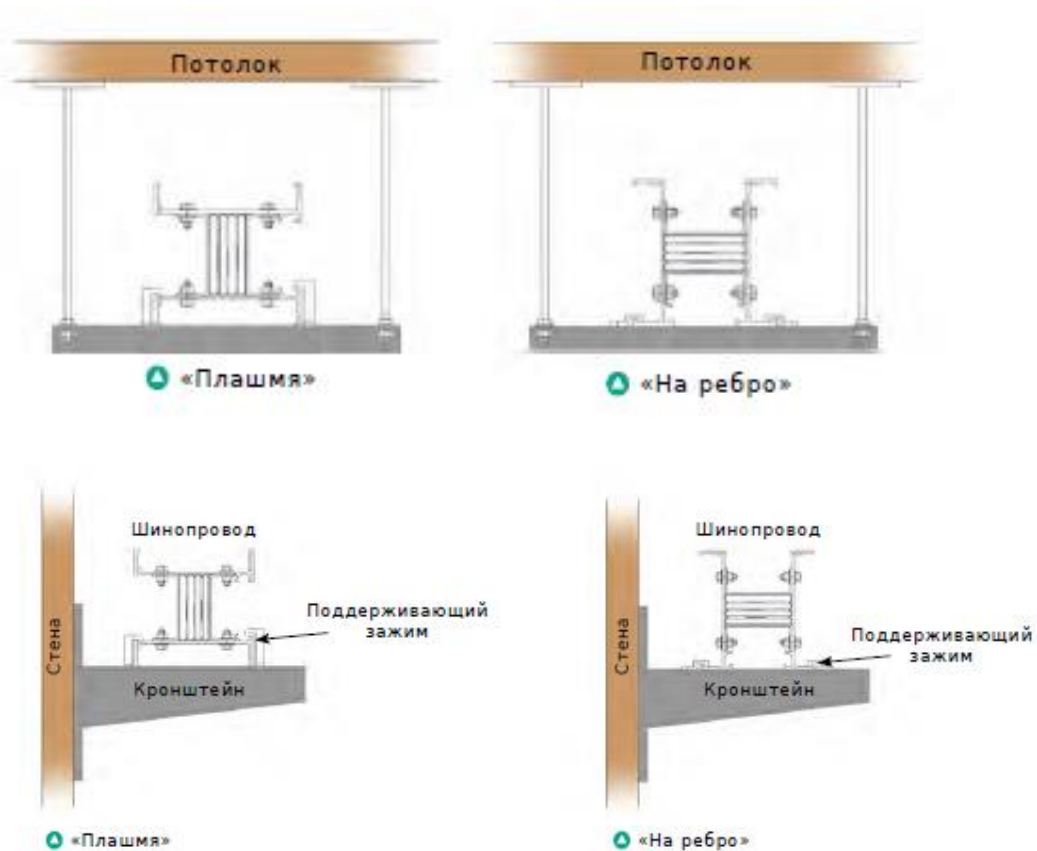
Горизонтальная установка на трапеции к потолку и на стенной кронштейн.
